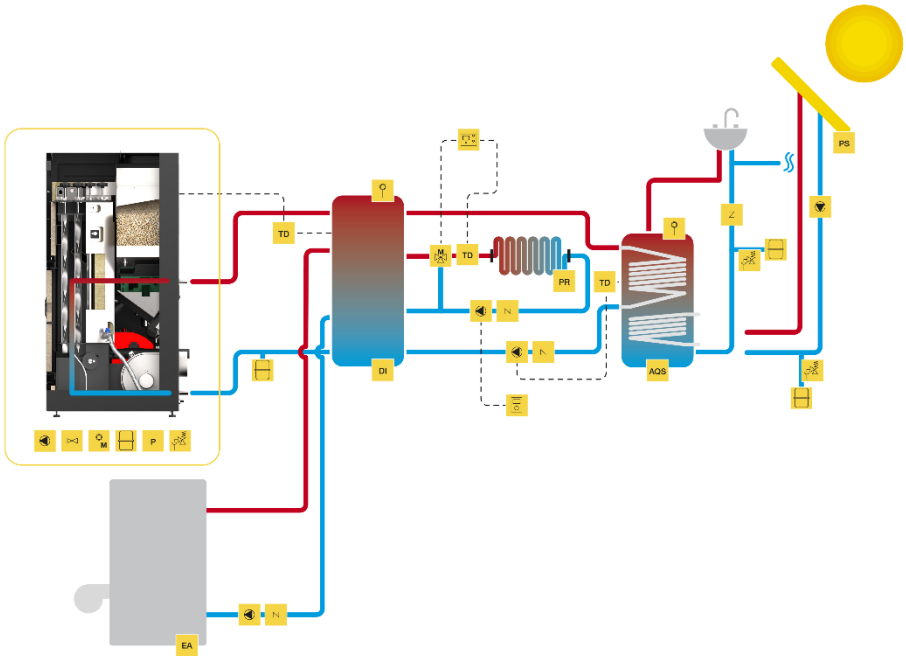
Connexion au sol chauffant, conjugué avec une autre chaudière de soutien et aux eaux sanitaires, associée au panneau solaire
